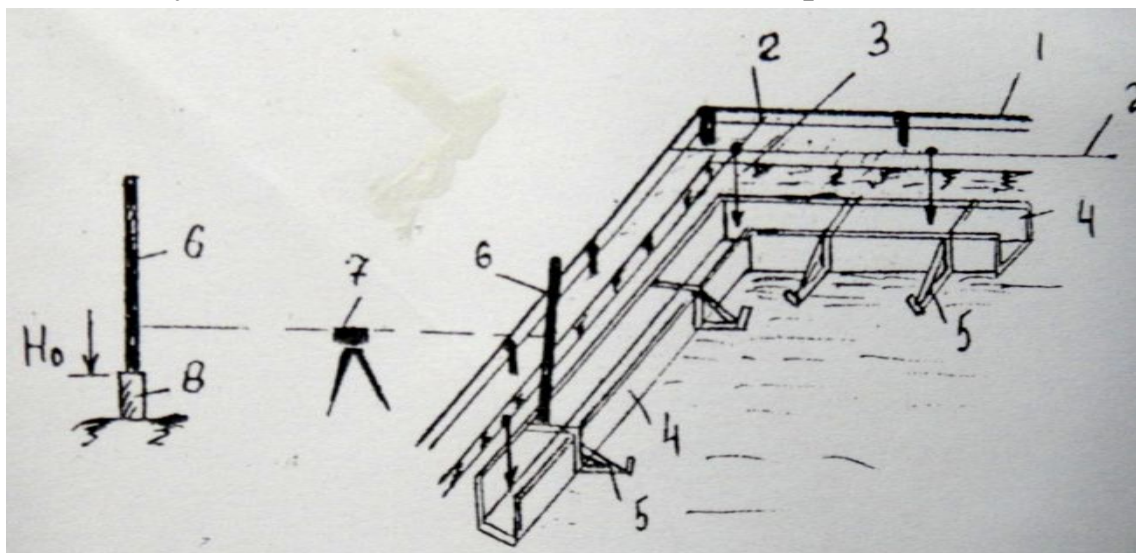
Разбивка опалубки ленточных фундаментов
